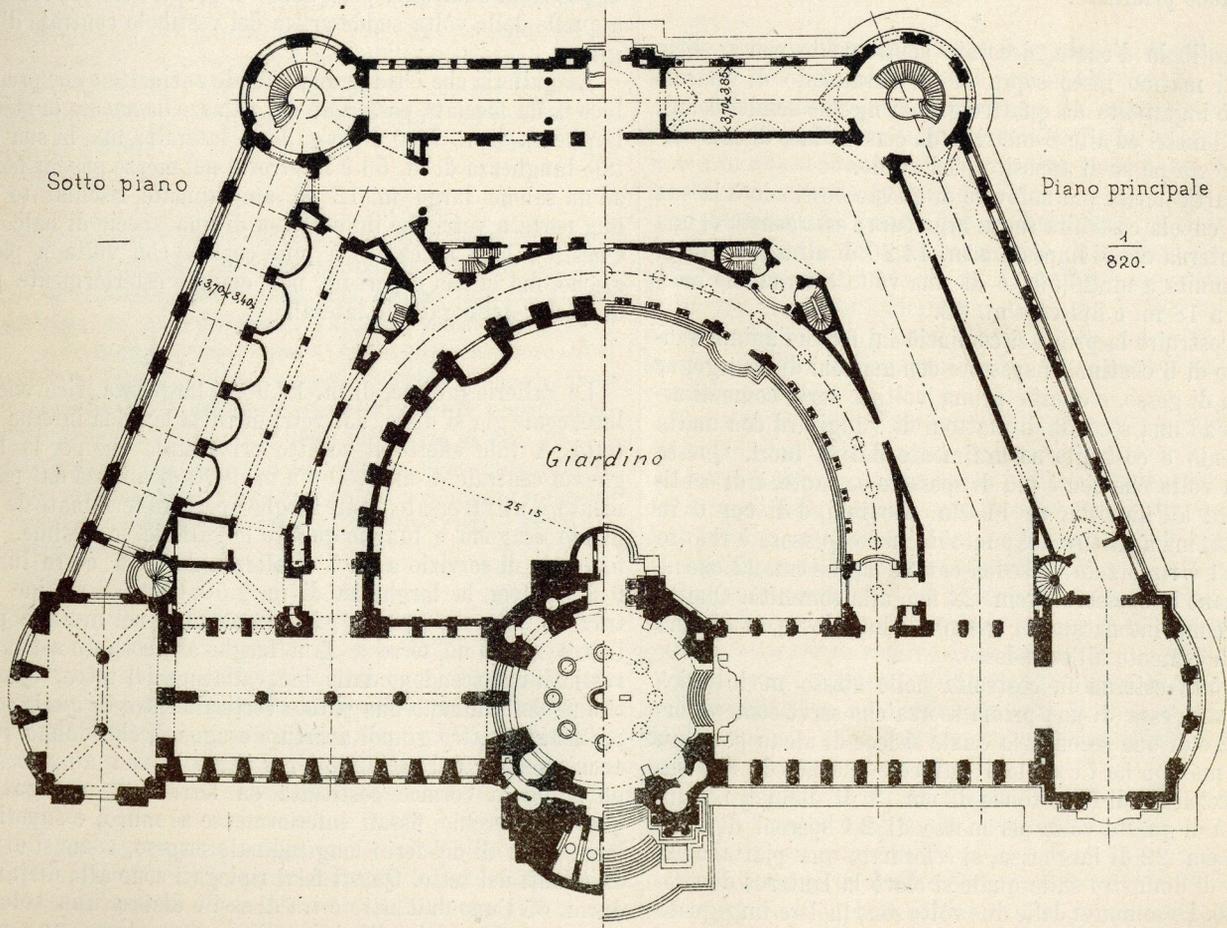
Pianta generale del Piccolo Palazzo, metà al piano principale, e metà al piano inferiore.
